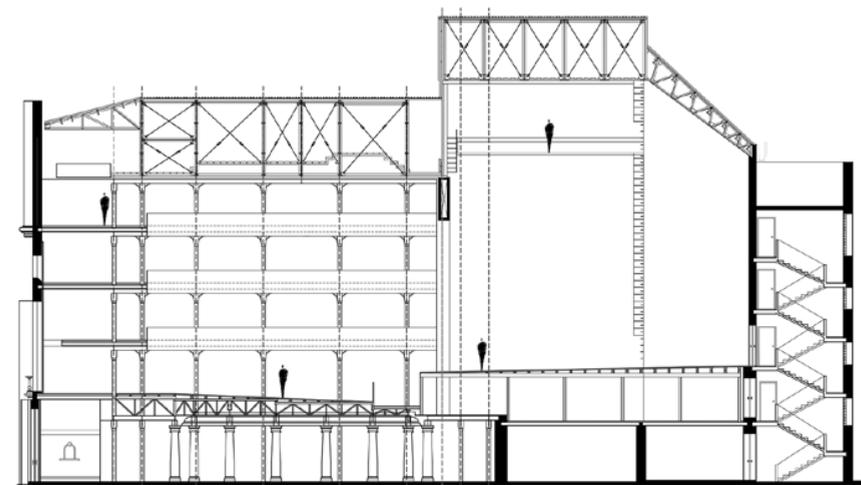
Corte longitudinal con interpretación del sistema constructivo original (1902). Dibujo: Ruth V. Morales con base en la interpretación de la autora..
